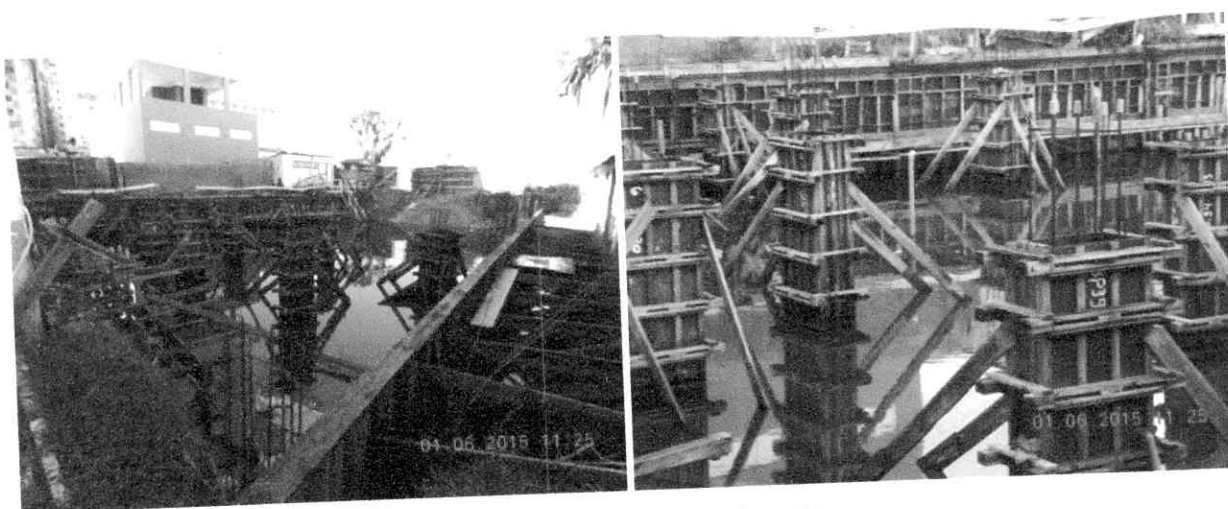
Vista parcial do interior do imóvel, infra estrutura em andamento.
